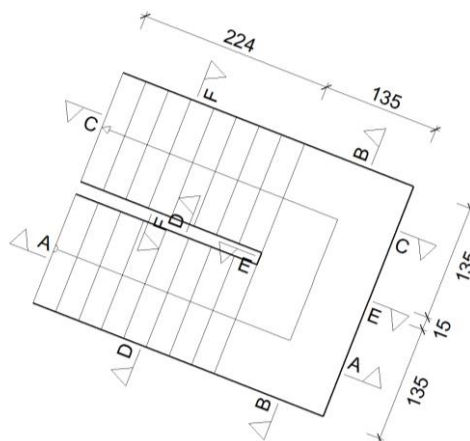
Dimensiones Escalera 1 tramo Sótano 1 a Planta Baja.
